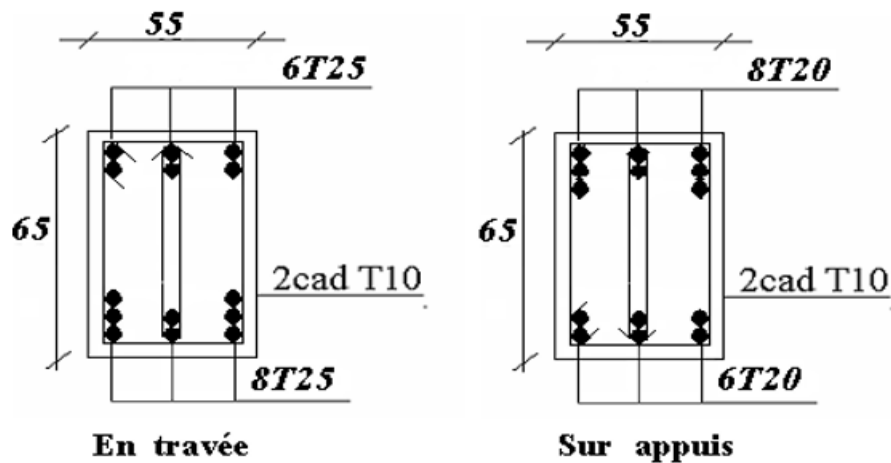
Ferrailage des nervures sens porteur et sens non porteur
